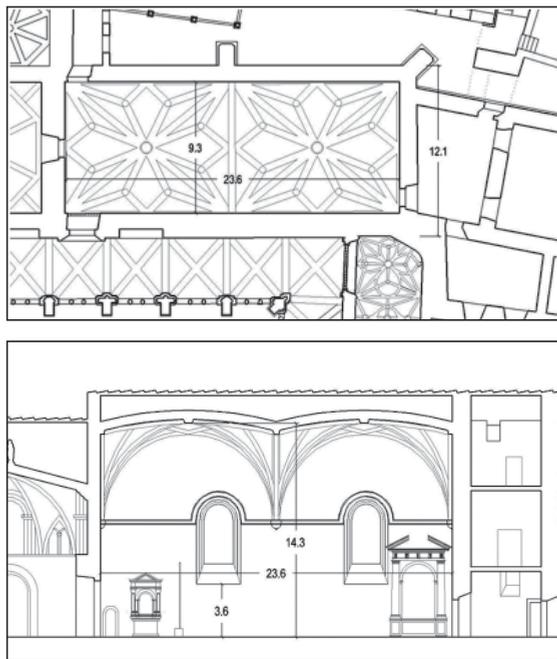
Dimensiones en planta y sección de la librería capitular de la catedral de Ávila. Interpretación propia sobre planos de P. Feduchi.
